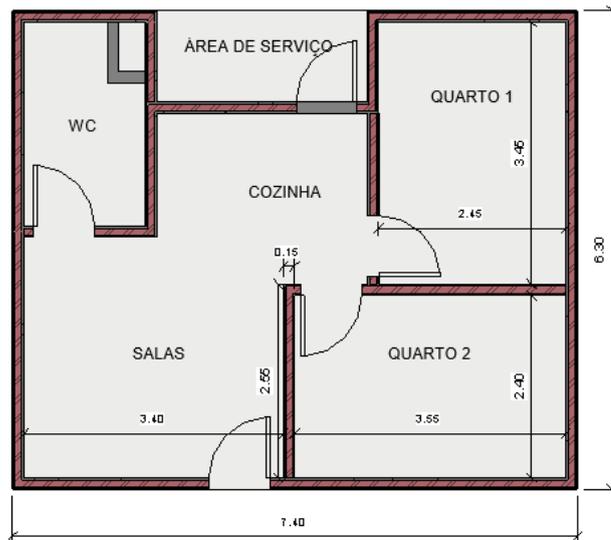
Planta baixa, projeto base desenvolvido no REVIT
